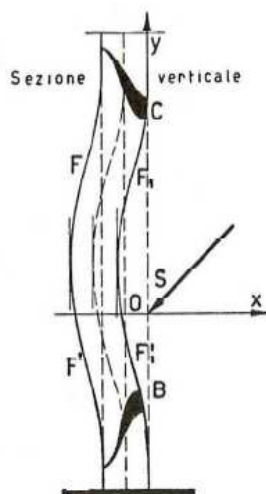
Fessurazione che si genera nel paramento sottoposto alla spinta nella sezione verticale del muro (Mastrodicasa, 1993).
